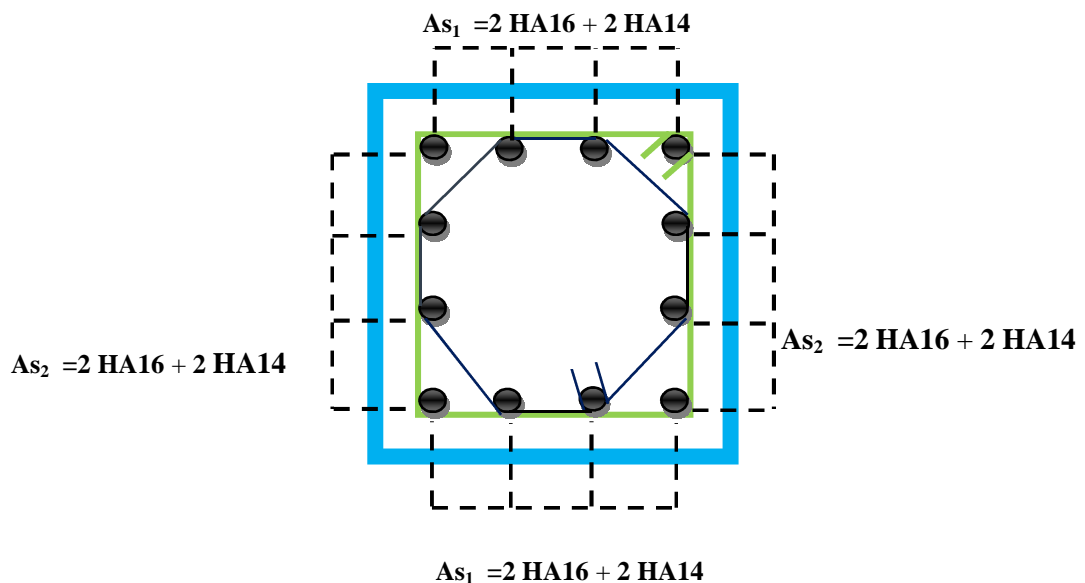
VI : Schéma ferraillage poteaux (50x50)
